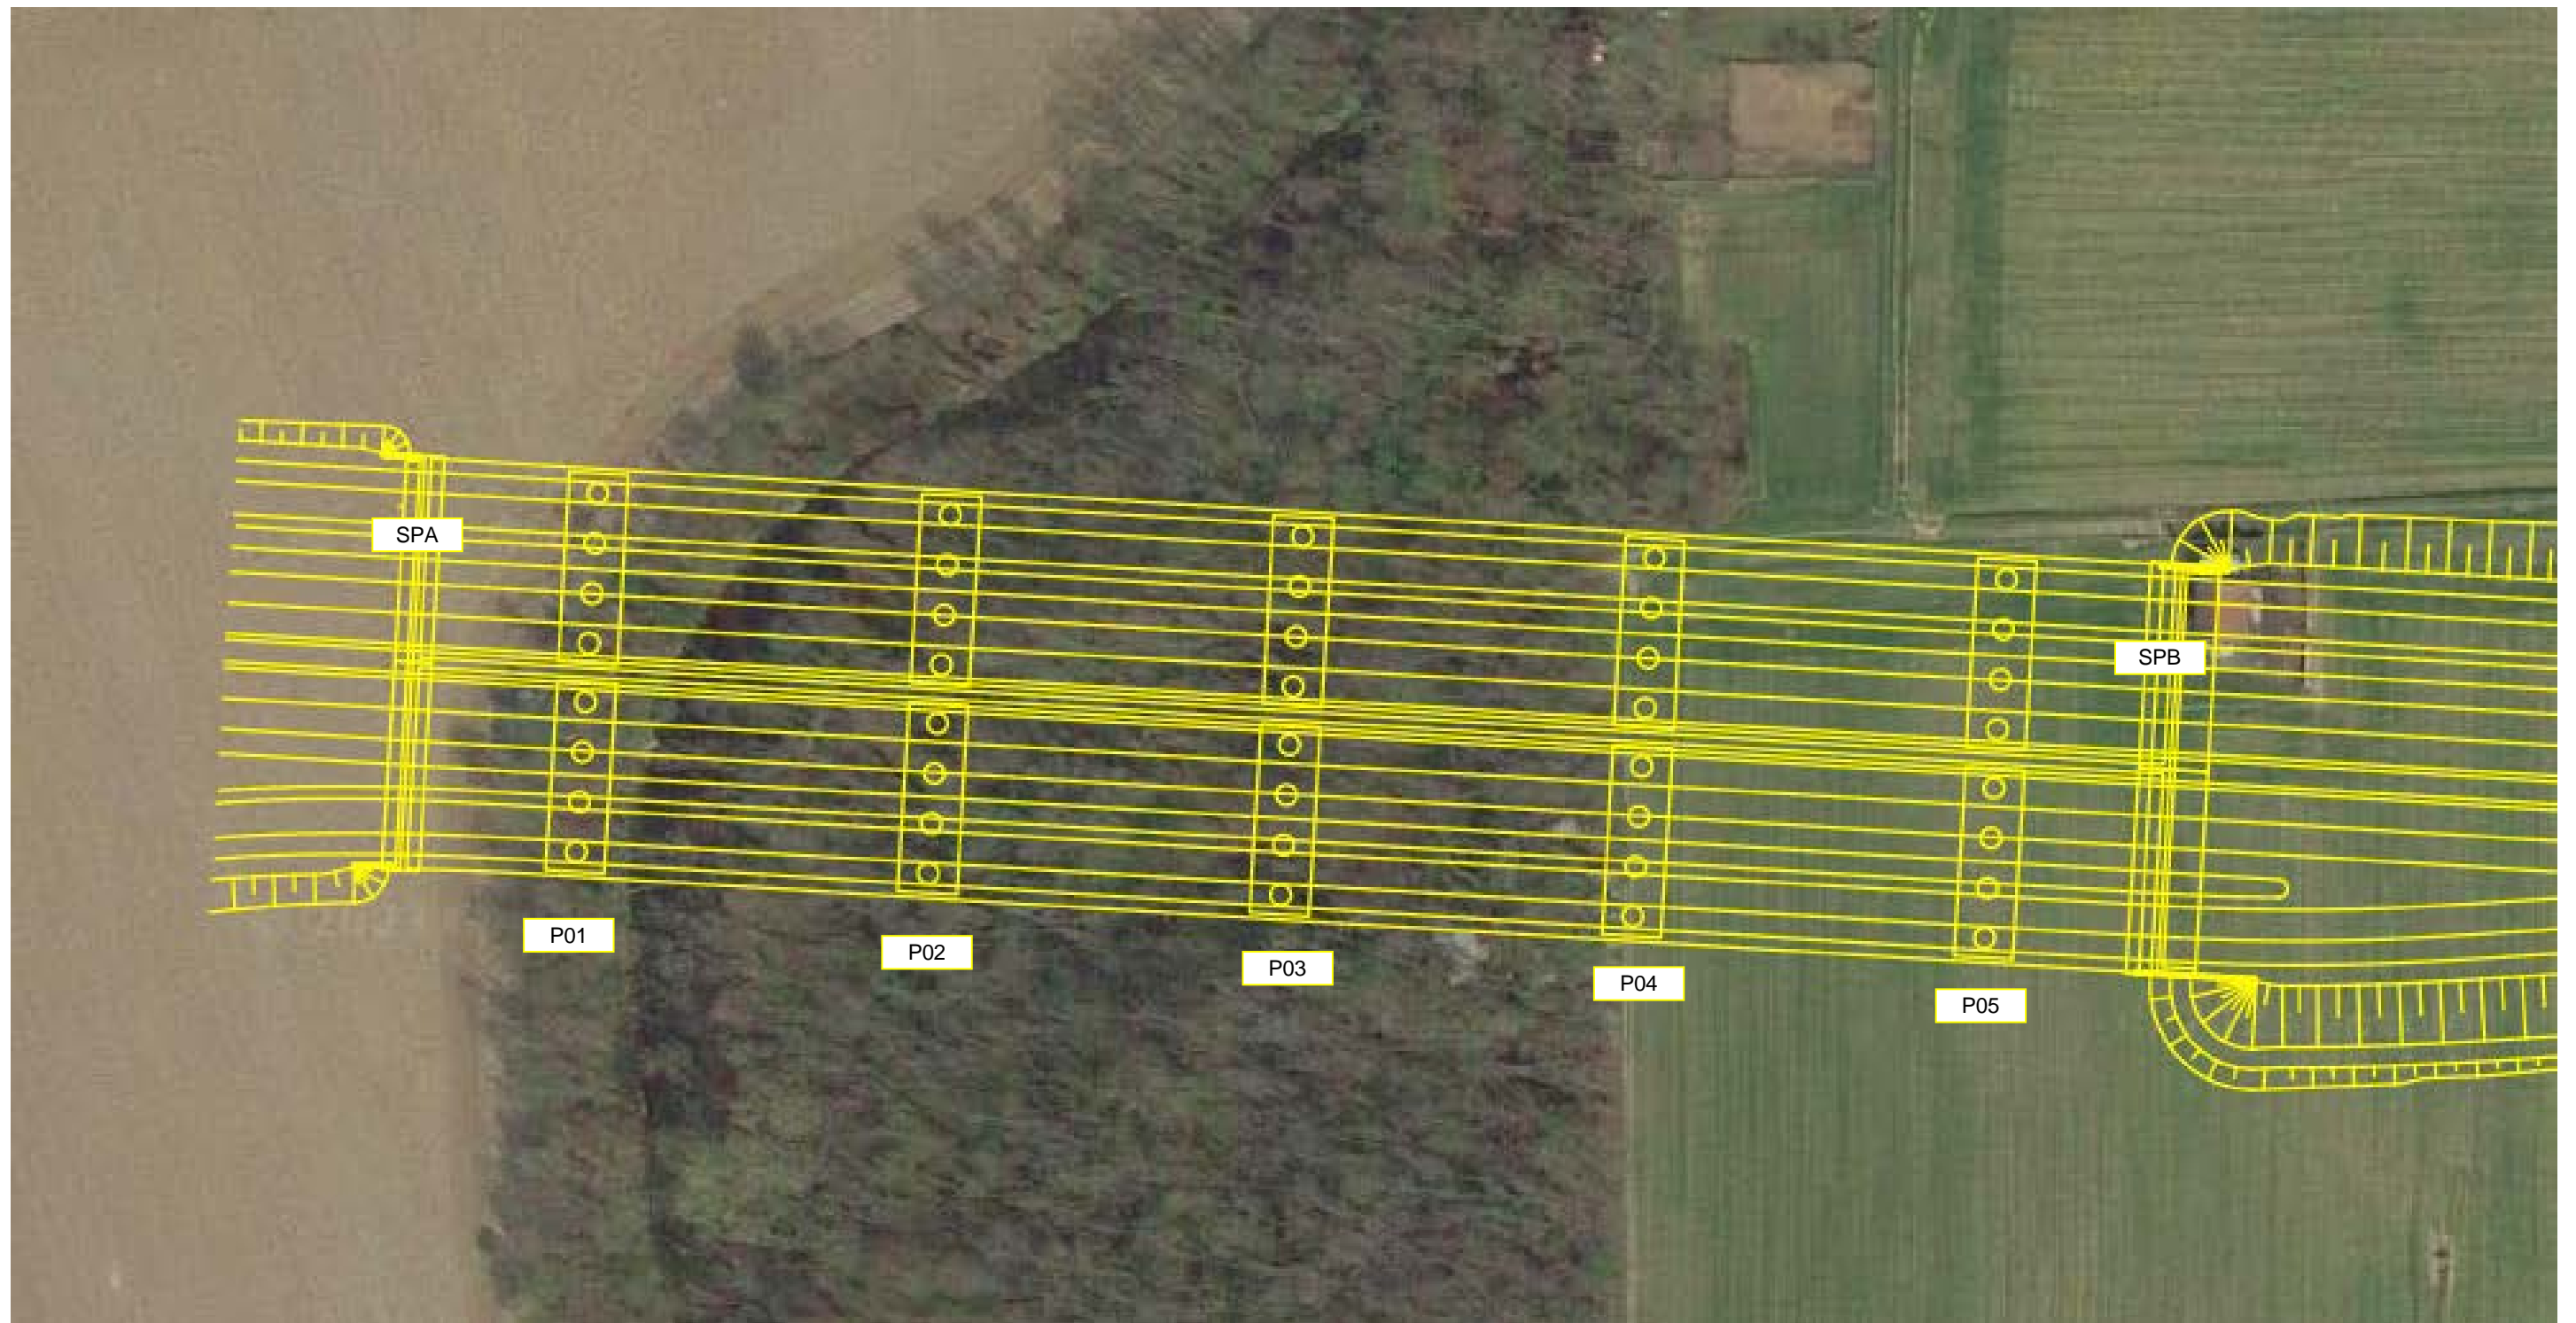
Planimetria dell'intervento su foto satellitare.
